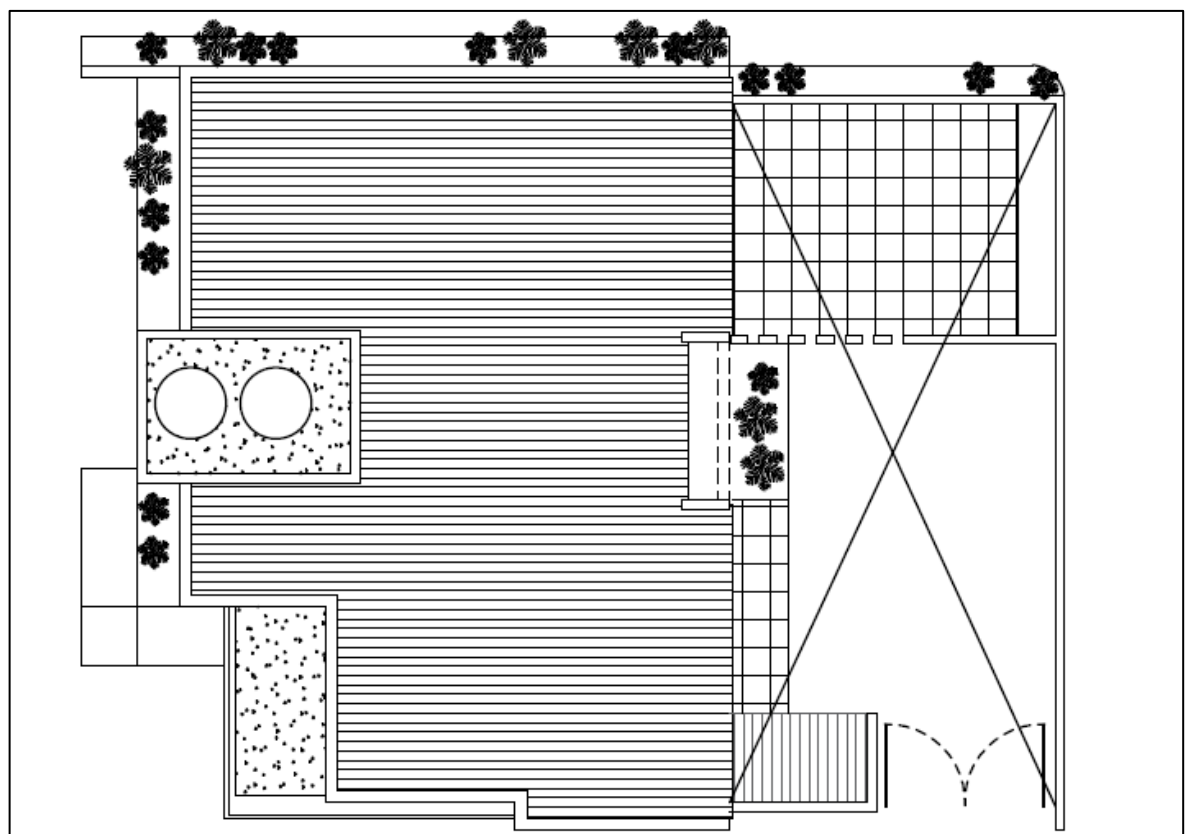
Plano de Layout de edificio – Cubierta y Losa de Tanques.
